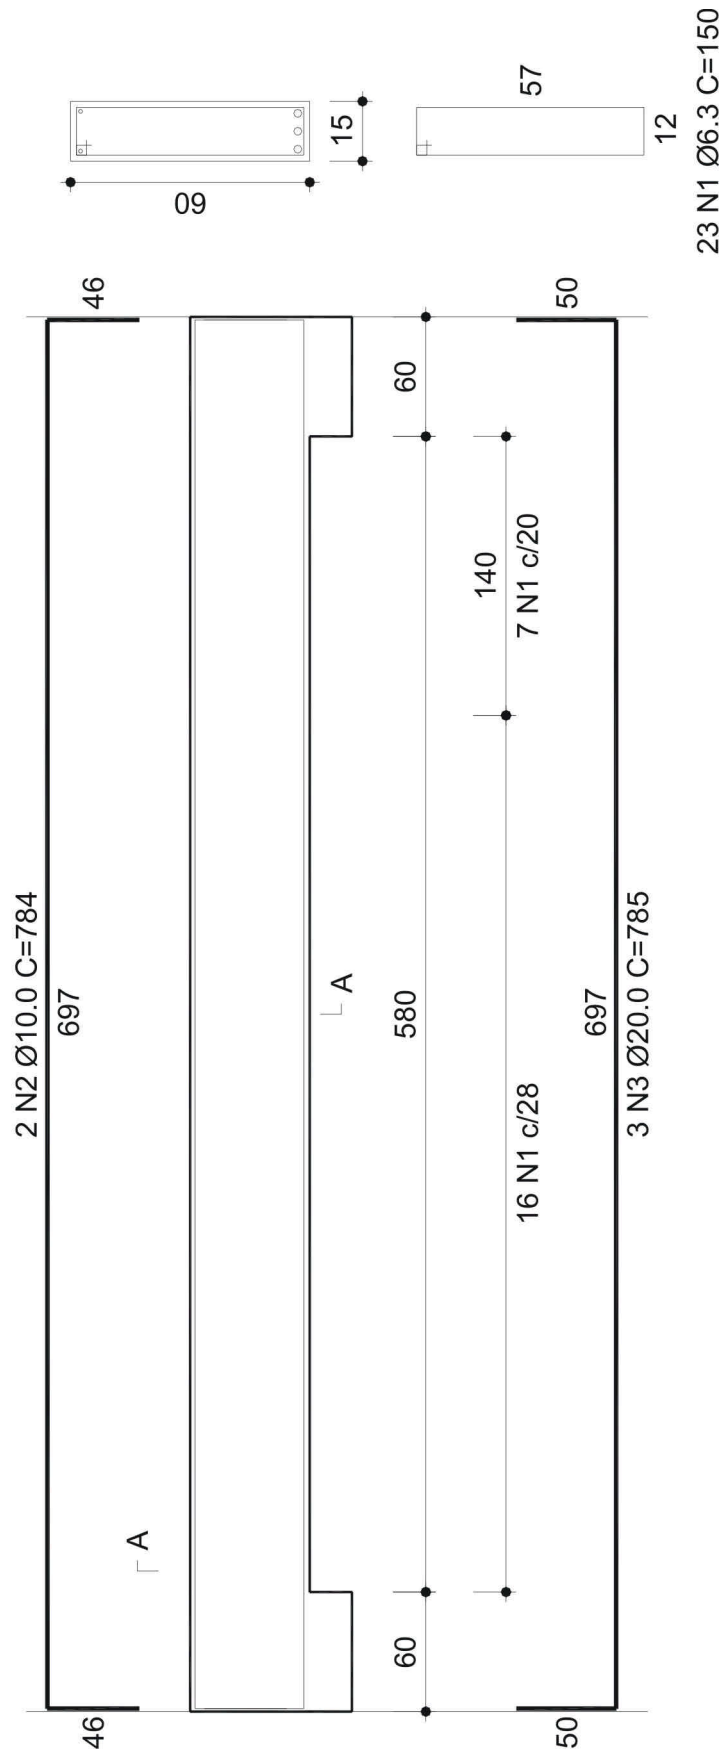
Detalhamento Viga 01, realizado pelo Eberick.
